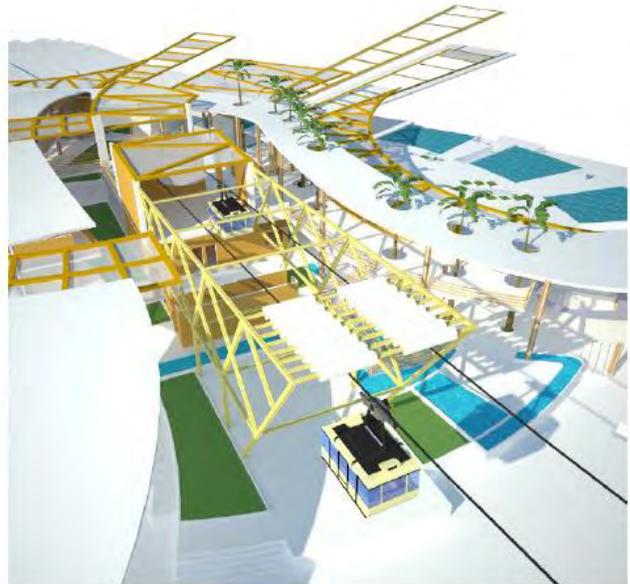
Vista tridimensional acceso teleférico del proyecto
